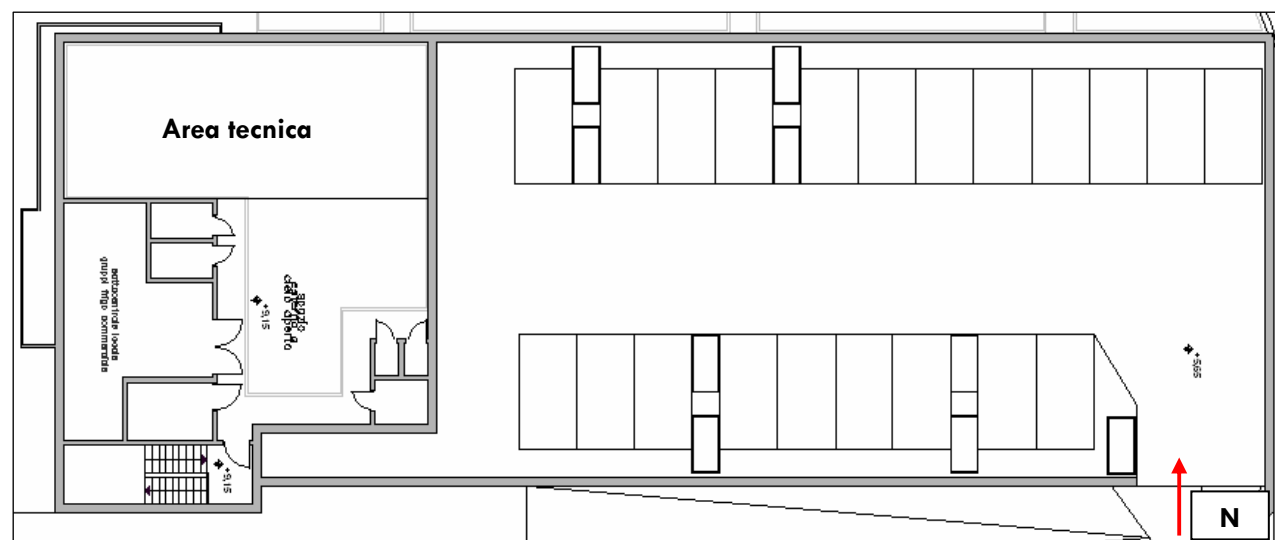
Progetto architettonico: planimetria P2 lotto n. 3
